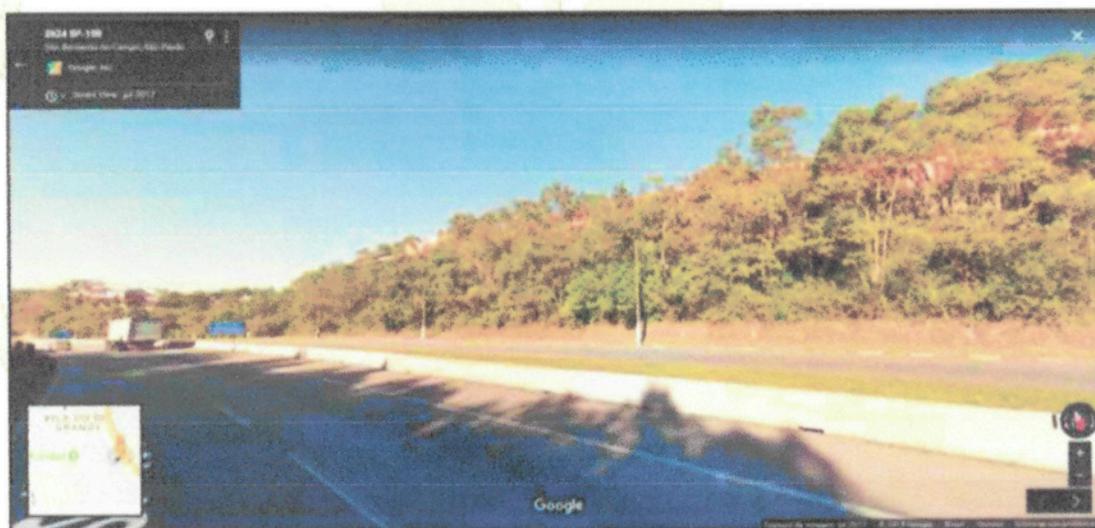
Avenida Marginal à Direita da Via Anchieta – Sentido São Paulo.
